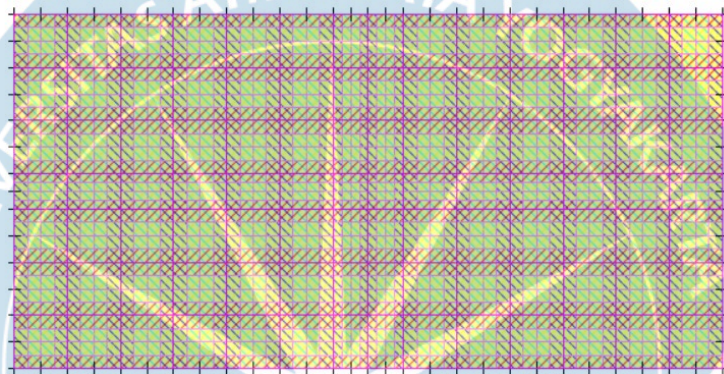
Layout pelat lantai 2, drop panel, column strip, dan middle strip
